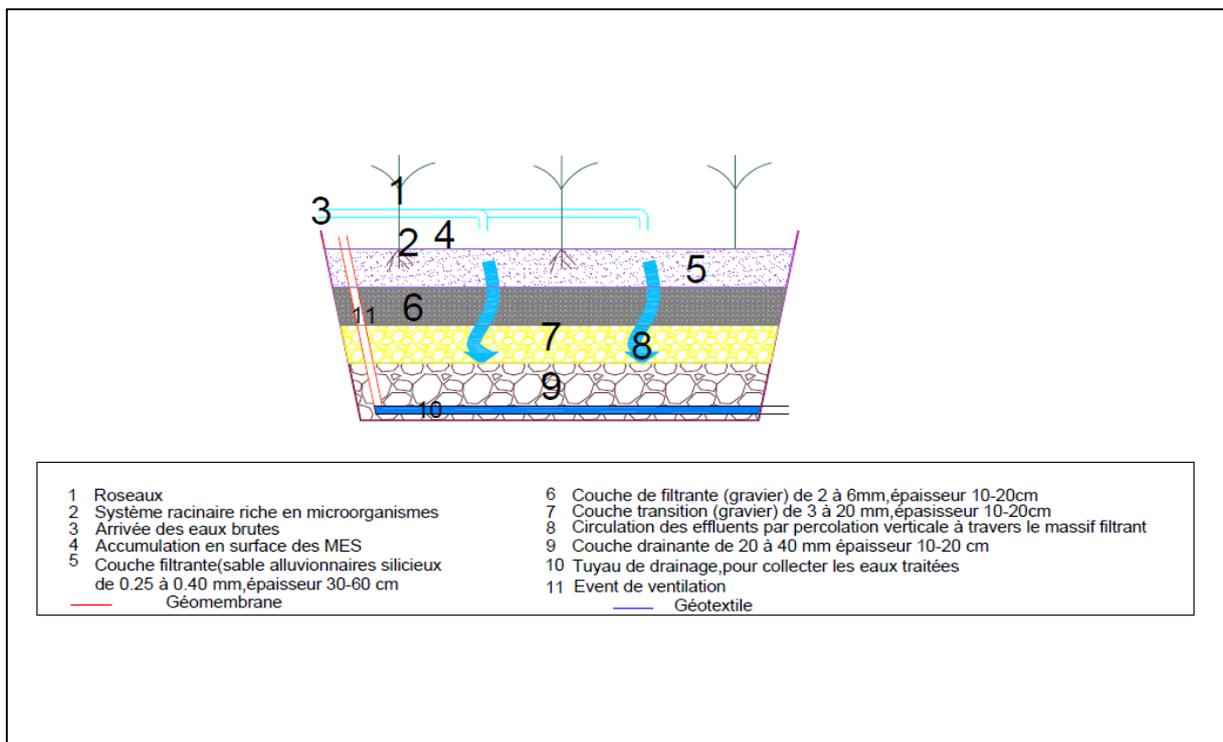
Coupe transversale d'un FPR à écoulement vertical au 2^{ème} étage
